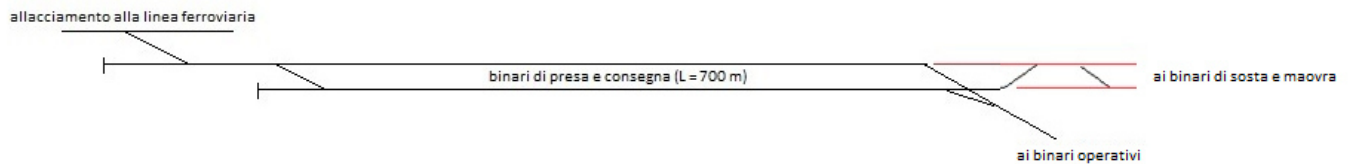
E – Layout schematico in pianta del fascio arrivi e partenze
